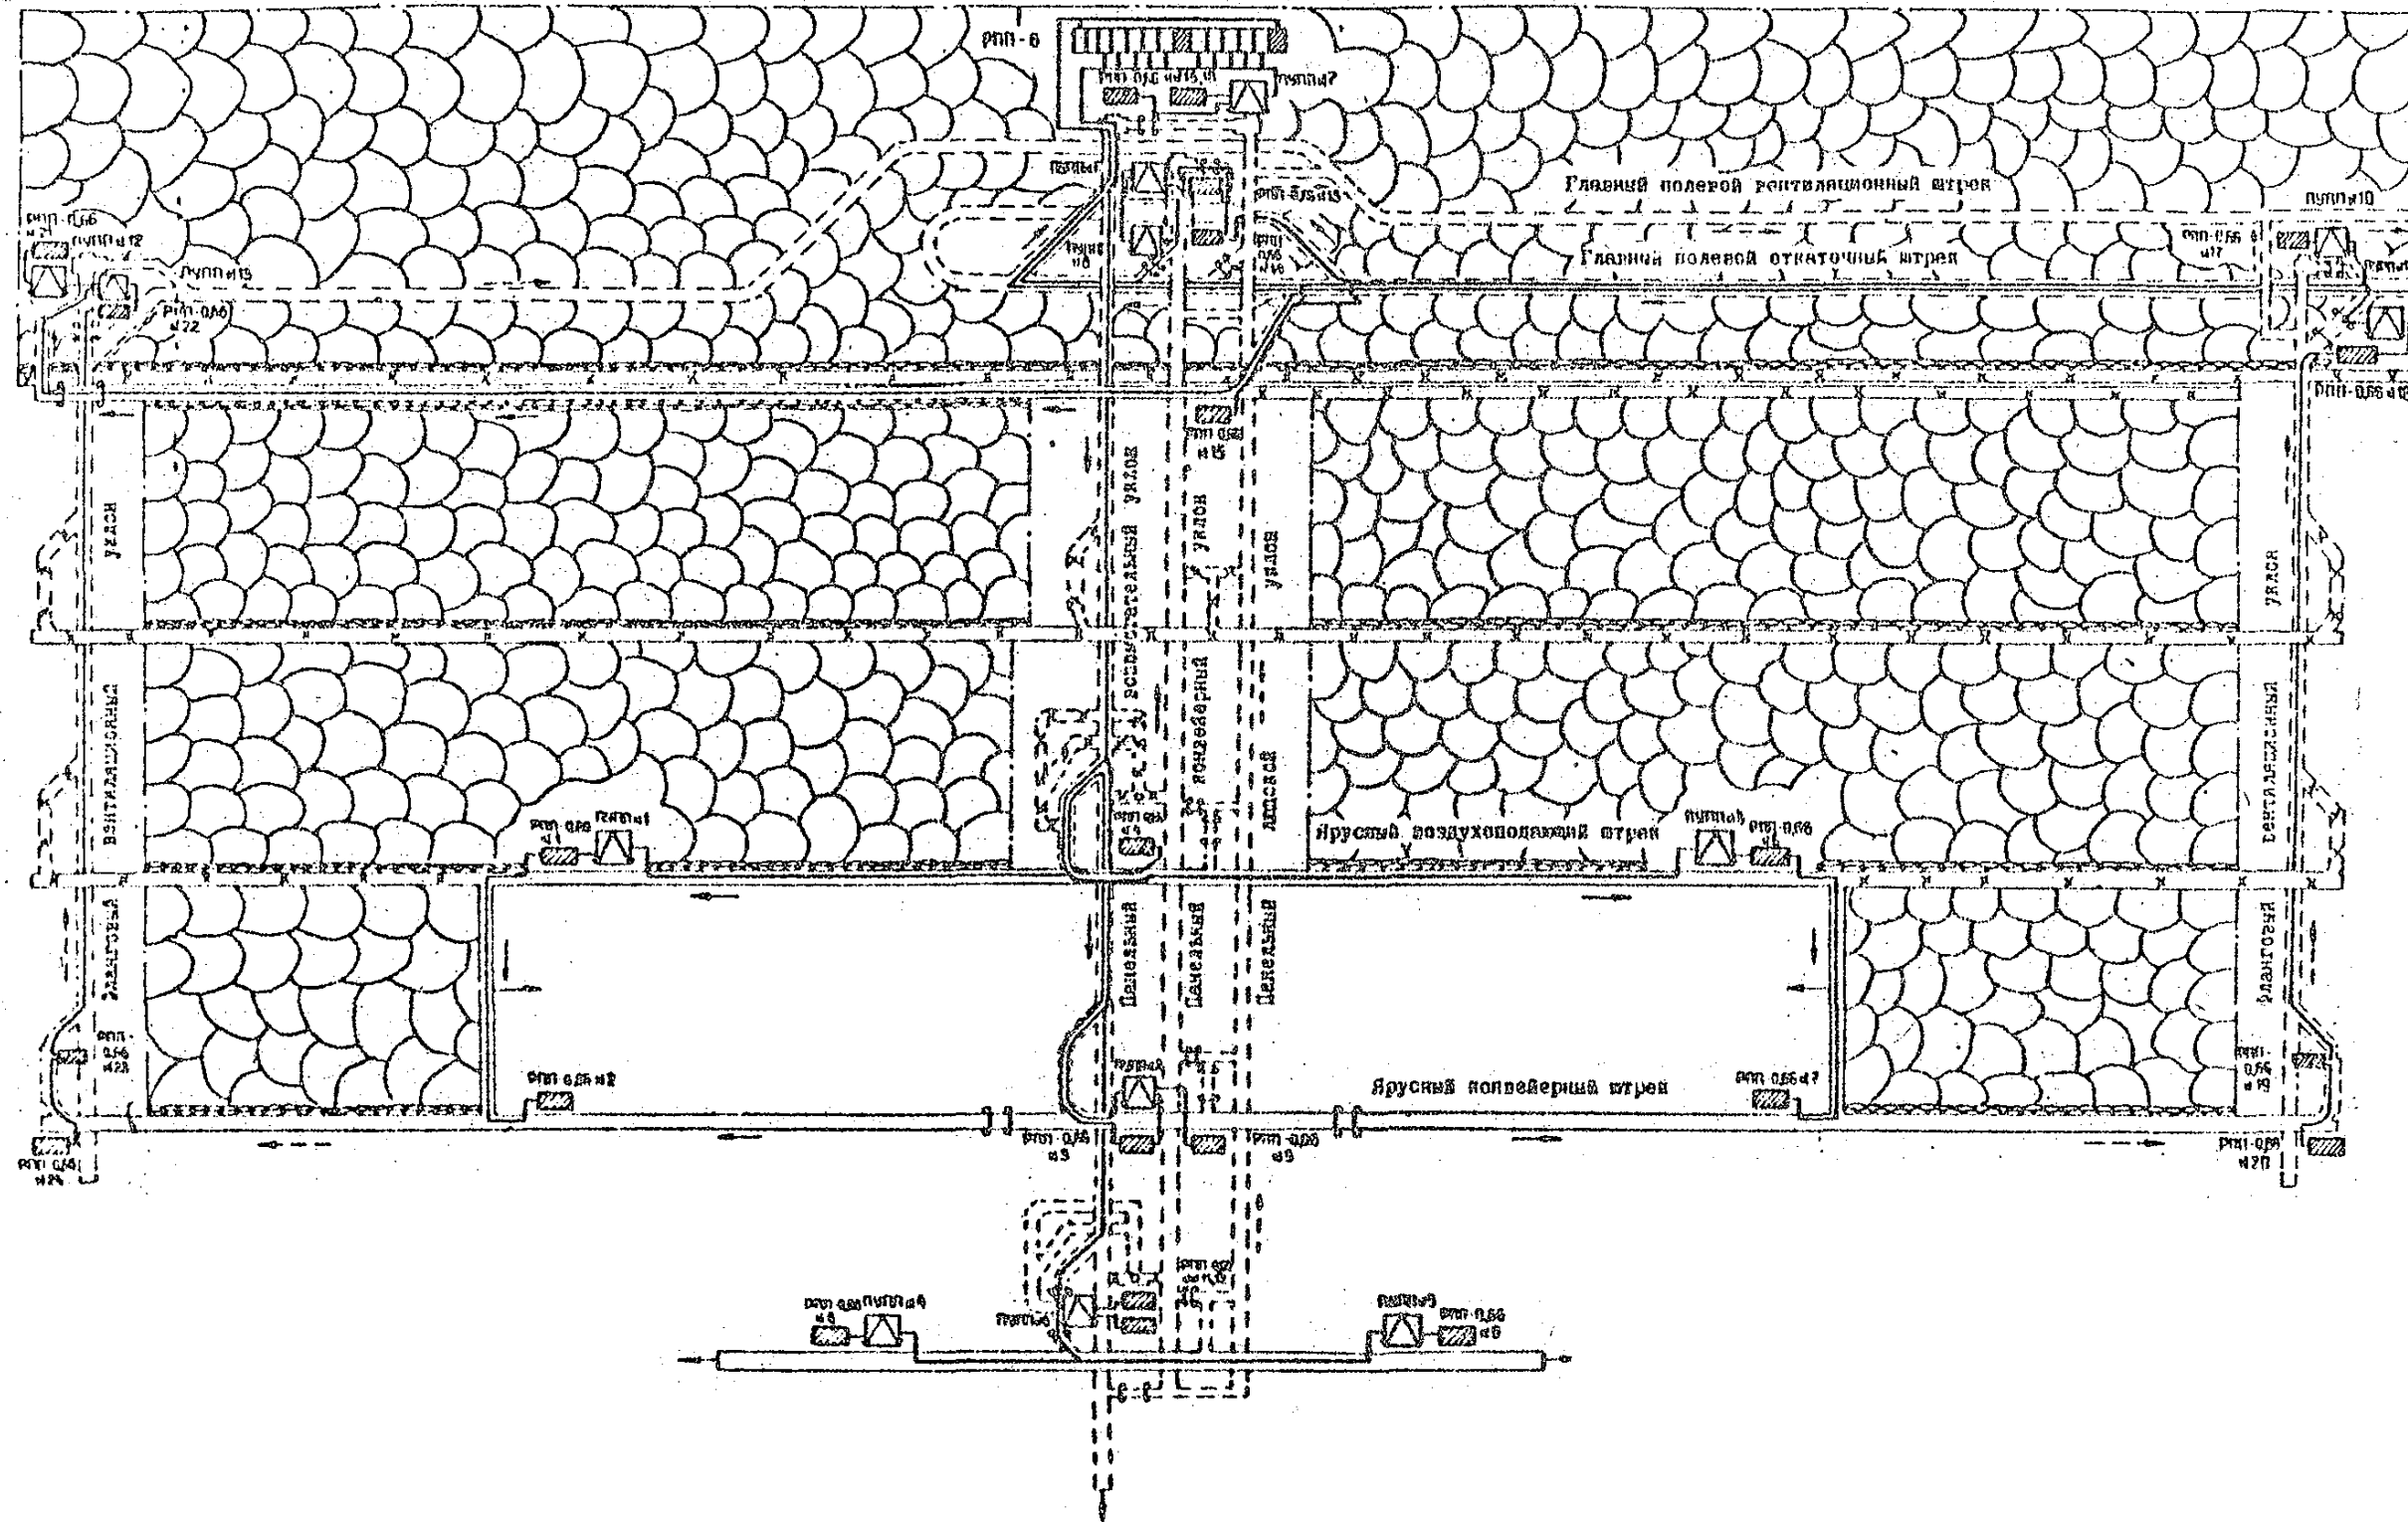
Схема размещения ПУШ, РПИ-0,66, РПИ-6 и кабельной сети на плане горных работ
